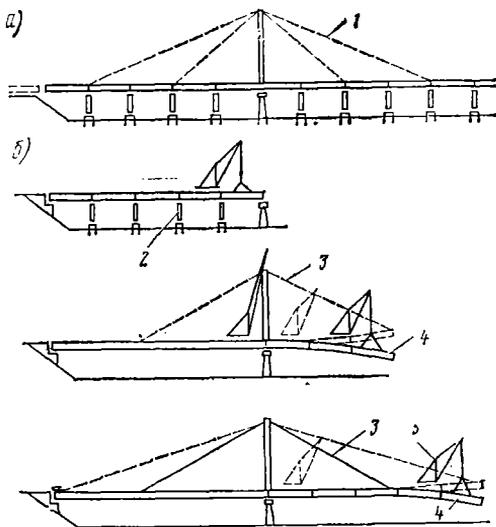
Схемы сборки вантового моста: 1 — постоянная ванта; 2 — вспомогательная опора; 3 — вспомогательная ванта; 4 — балка жесткости; 5 — жесткоугольный деррик-кран
